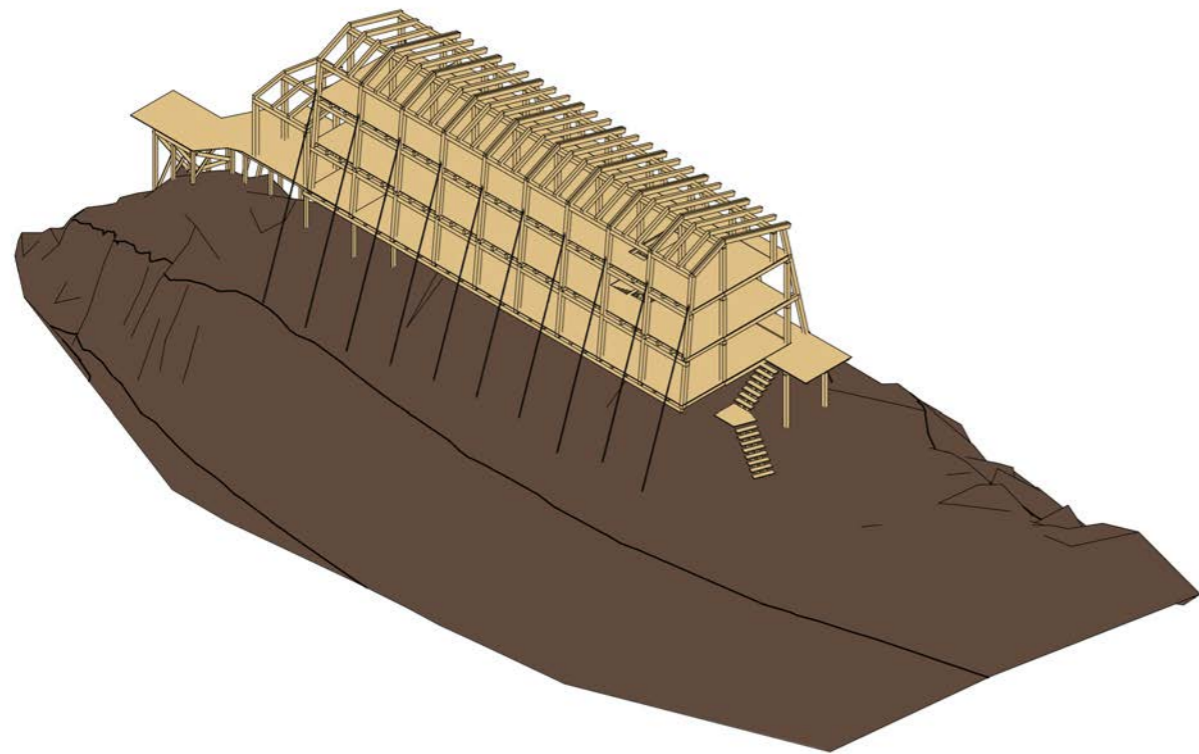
Fase 2 costruzione elementi orizzontali solai e scale.
